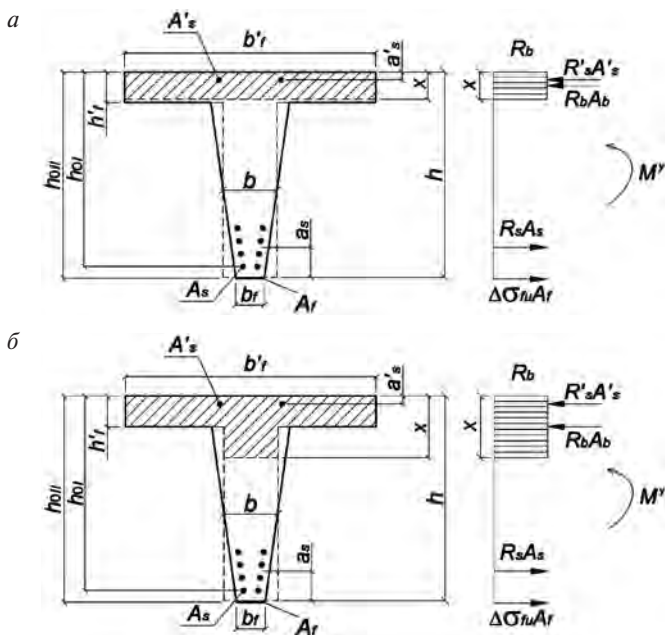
Расположение внутренних усилий и форма эпюры напряжений в сжатой зоне бетона в предельном состоянии для таврового сечения, перпендикулярного к продольной оси усиленного балочного железобетонного элемента композиционным материалом:
